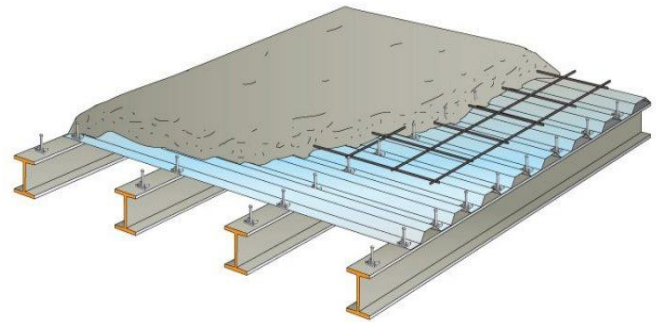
Plancher mixte acier-béton de type bac acier + connecteurs
